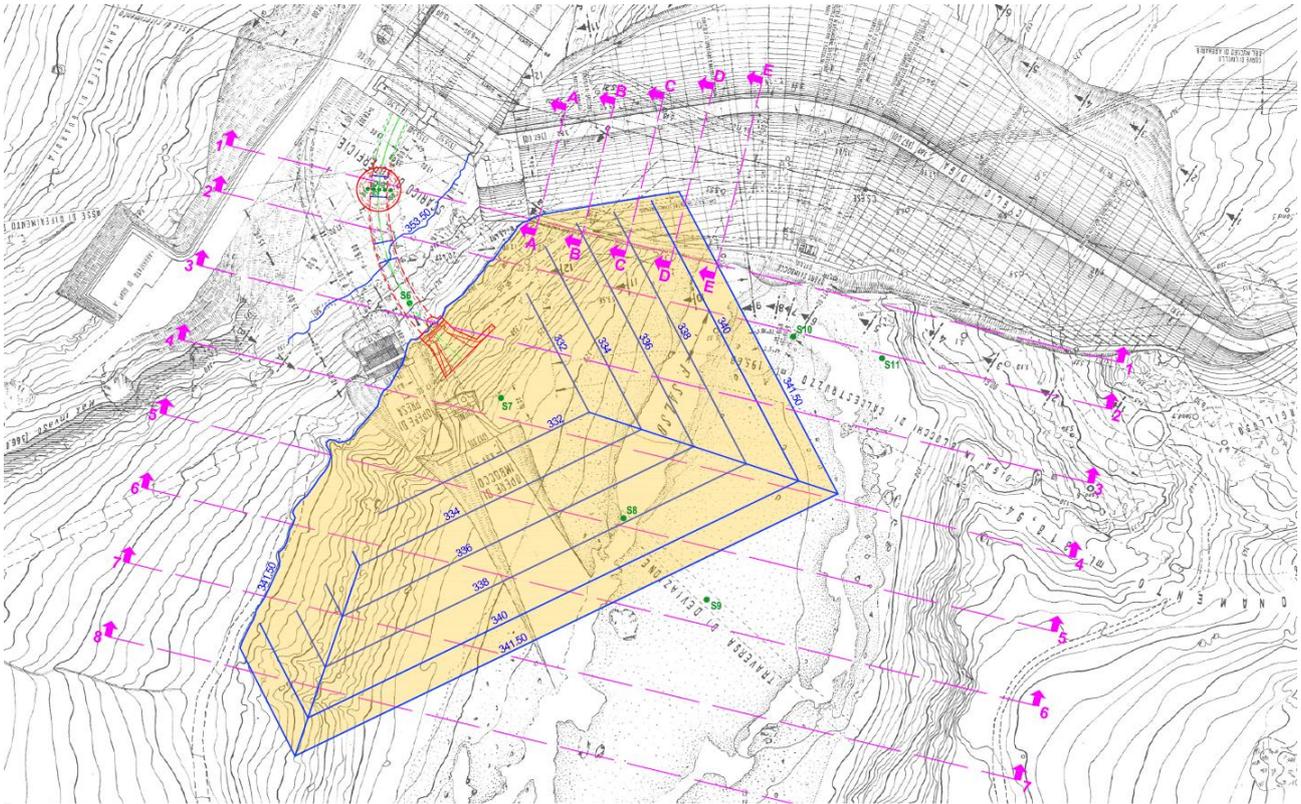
Tavola 2 - Planimetria Area Dragaggio
